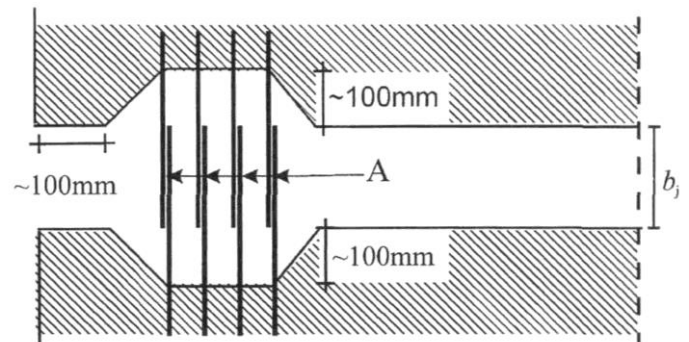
Розтягнута арматура, можливо потрібна на краях стін
